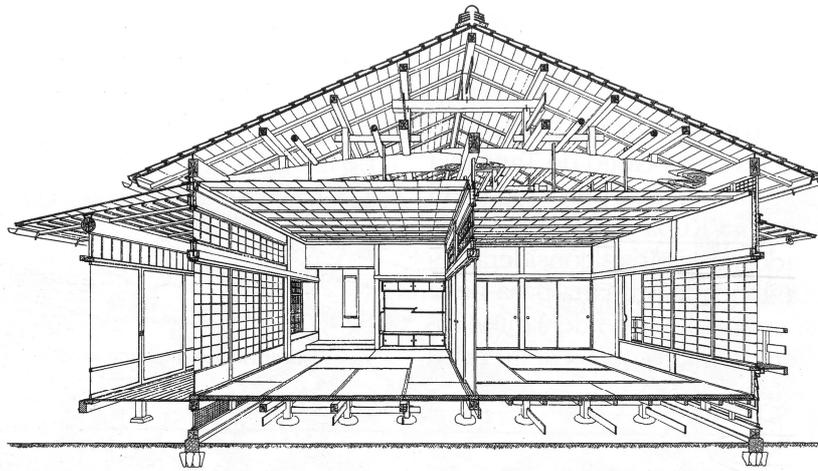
Sección en perspectiva de la casa tradicional japonesa de una sola planta.
